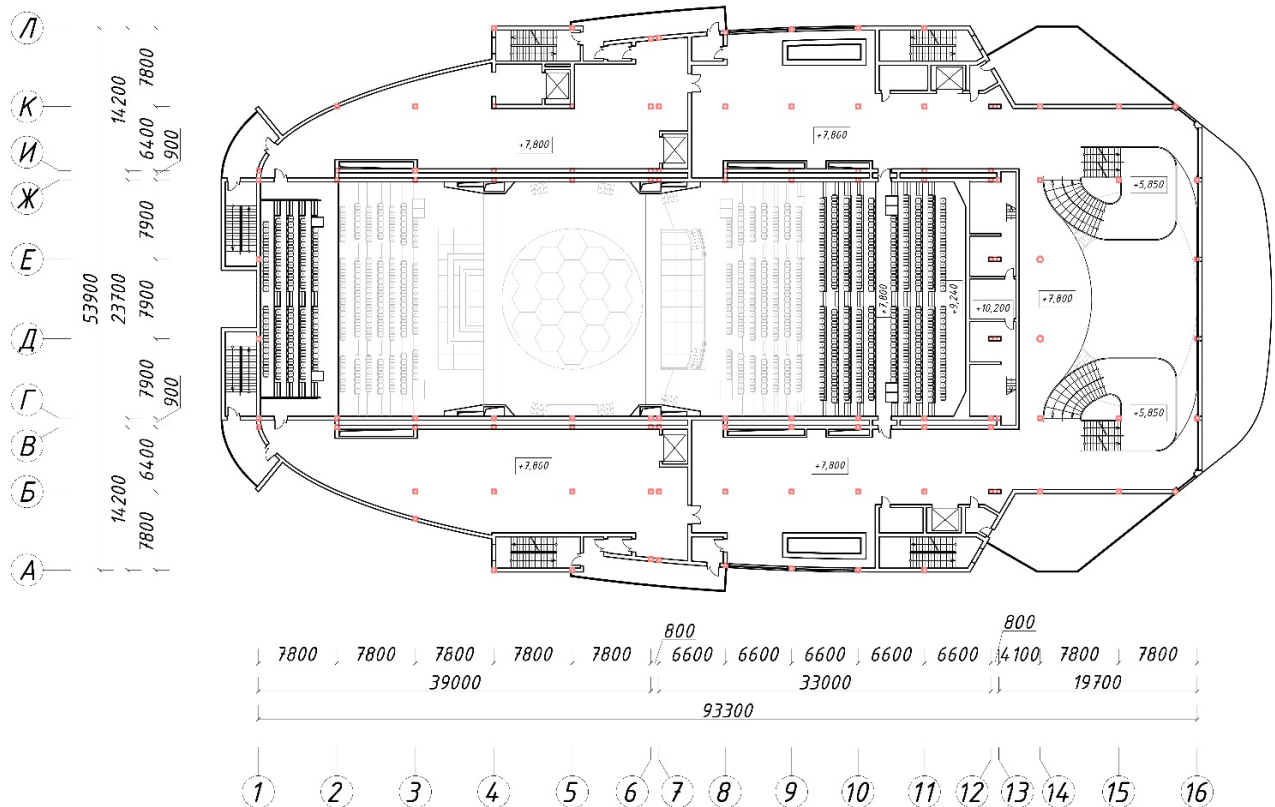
Схема-план поверху на позначці +7.800.
